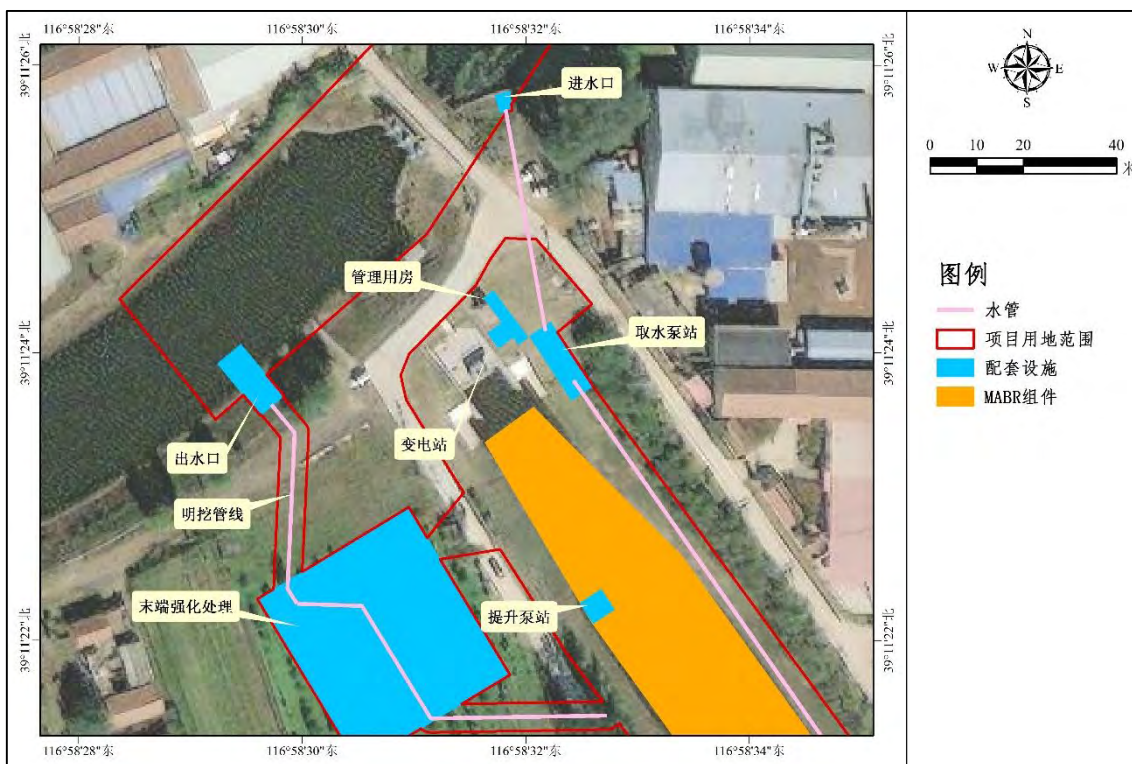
建设项目平面布置图（工程起点处局部放大图）
